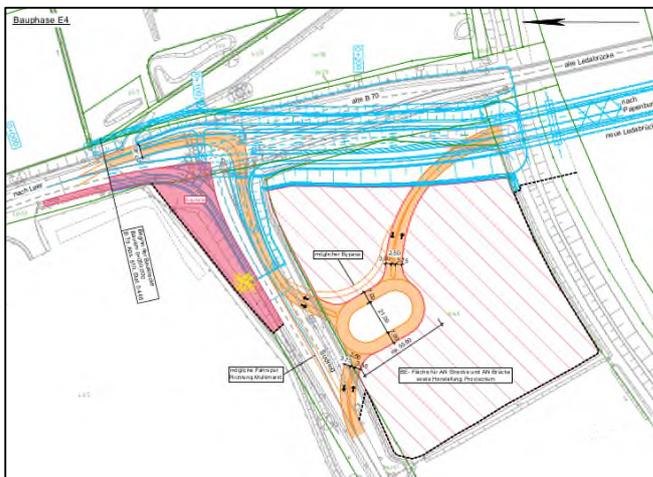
Lageplan Bauphasenplan Nord, Bauphase E4
